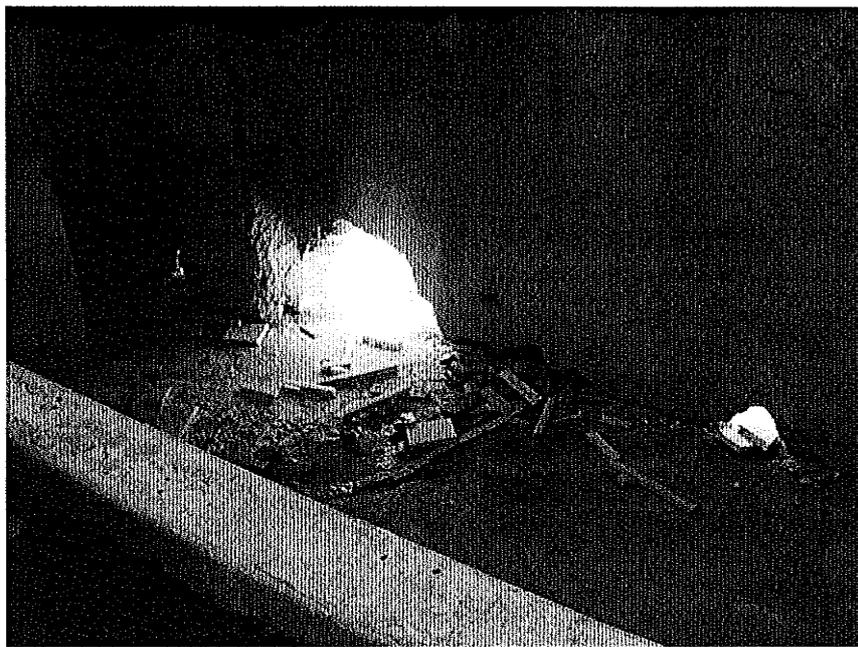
Particolare carenze strutturali – Fabbricato A
